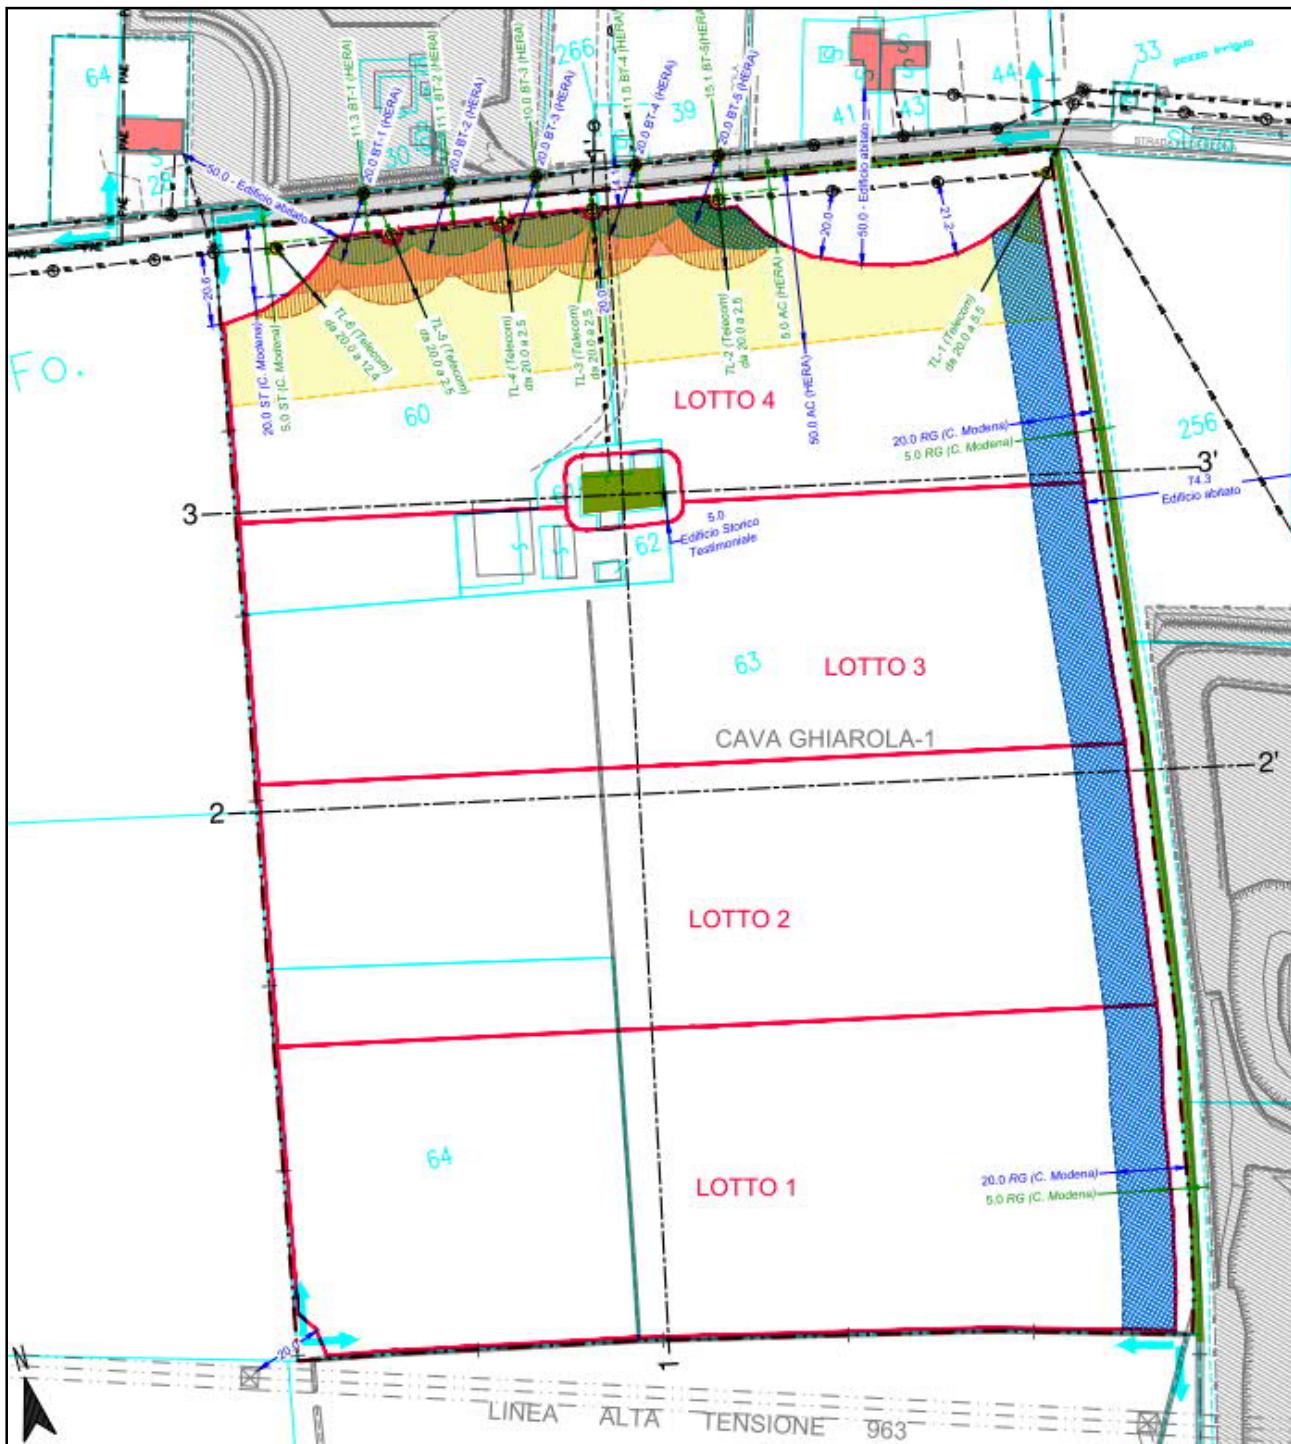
Estratto della Tavola T4i “Progetto – Planimetria dei vincoli di cui all’art. 104 D.P.R. 128/59”; fasce di rispetto dei vincoli.
